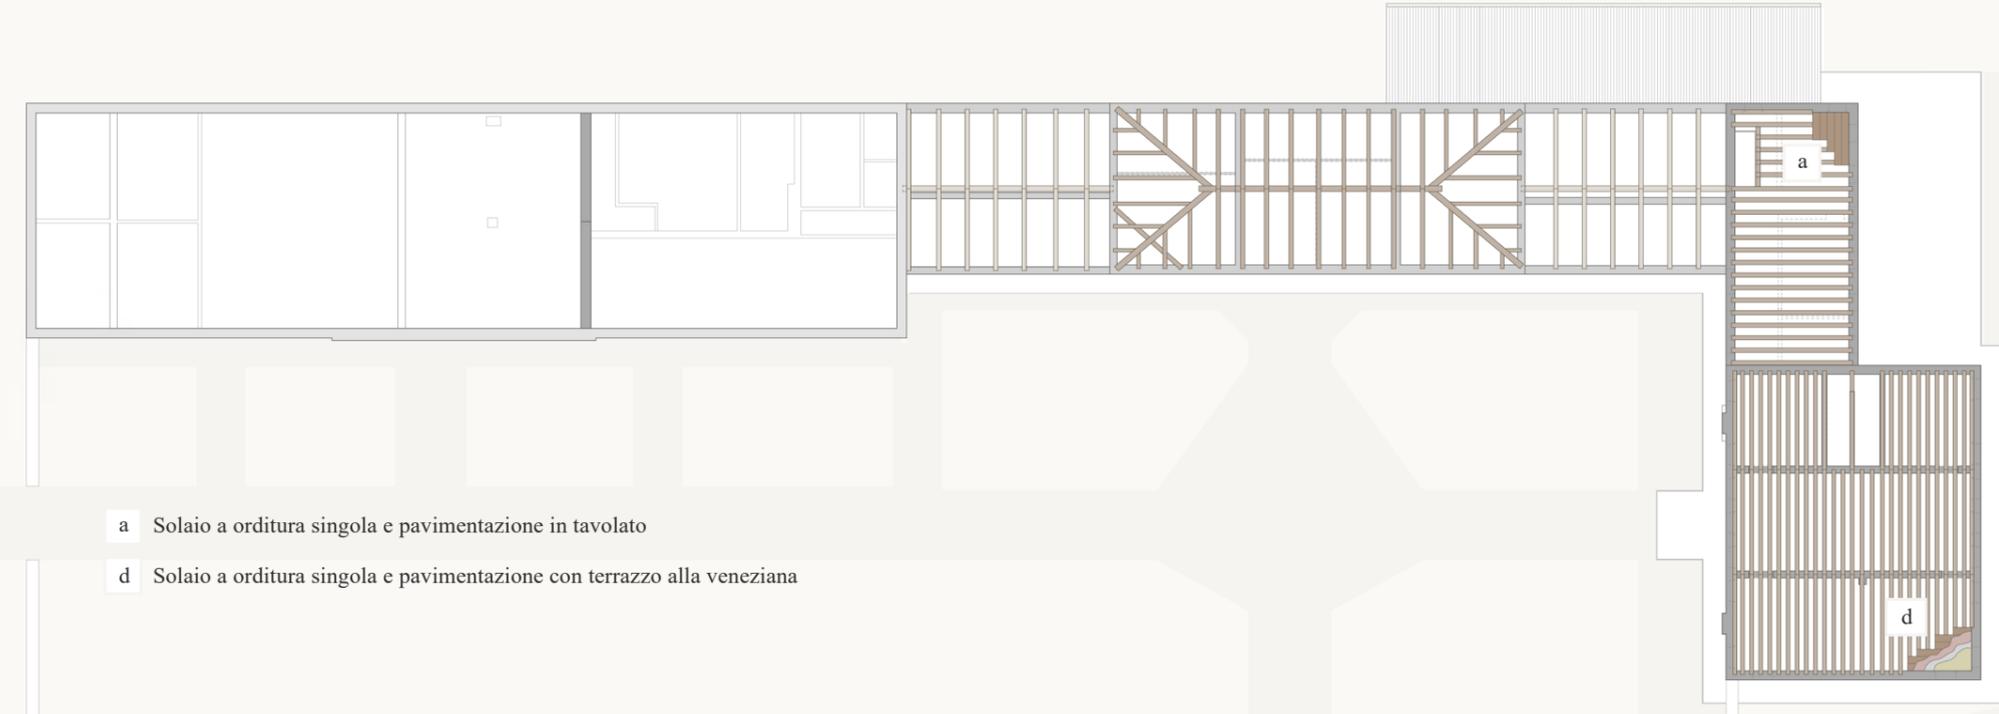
Pianta piano primo, rilievo costruttivo, fuori scala
